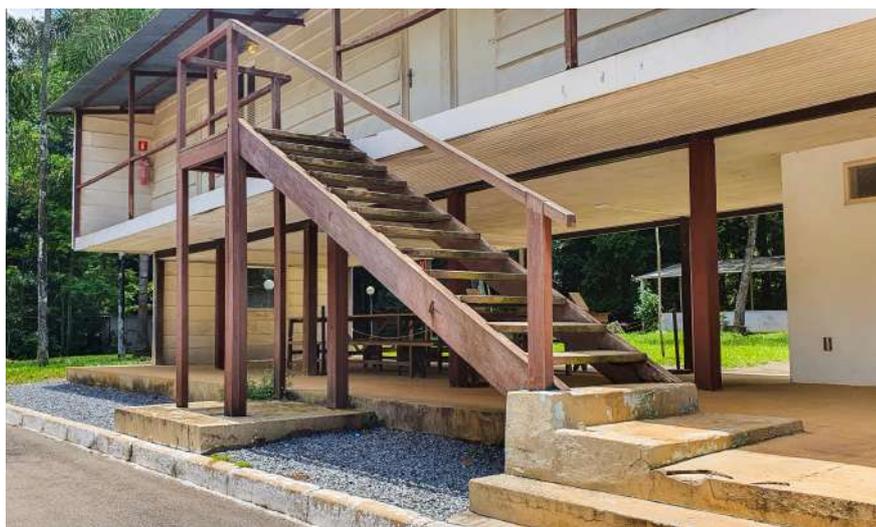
Detalhe da escada, único acesso, ao primeiro pavimento do Catetinho
